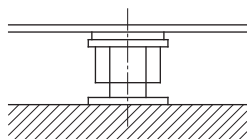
Нівелірні гвинти на поверхні фундаменту
